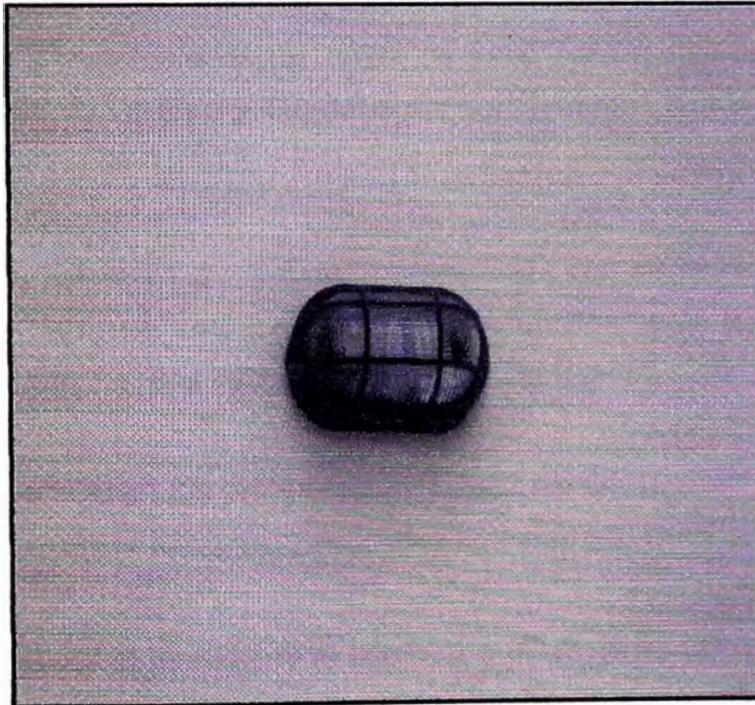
Detalle de Equipo de Iluminación para las áreas comunes
